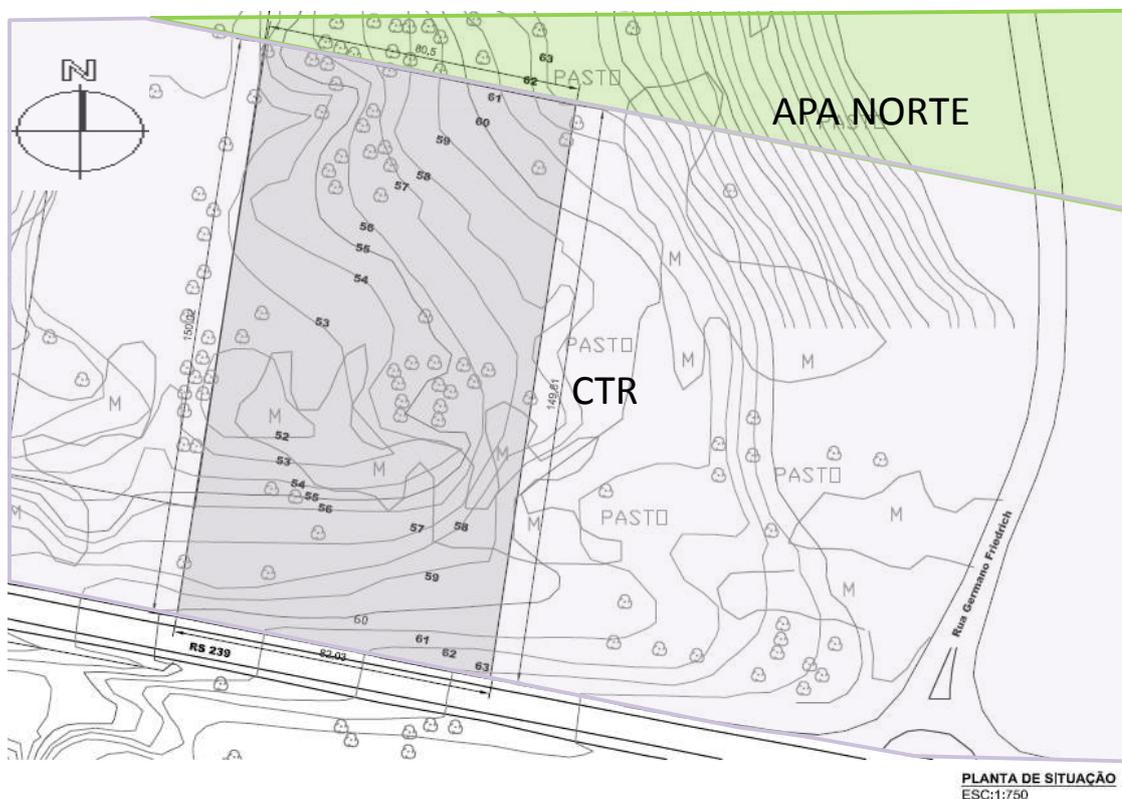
Planta de situação do lote escolhido (AUTORA, 2010 – Ver planta ampliada no ANEXO 6).
